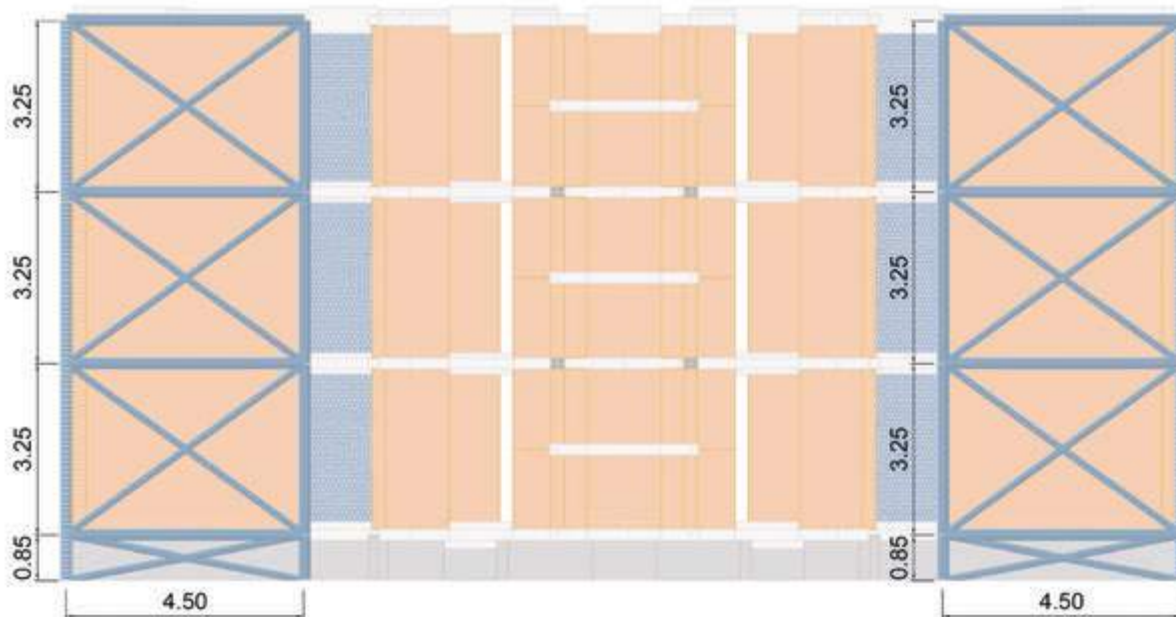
| Prospetto Sud con le nuove pareti di rinforzo reticolari
